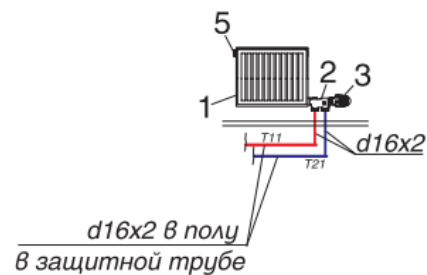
Схема присоединение трубопроводов к отопительному прибору
